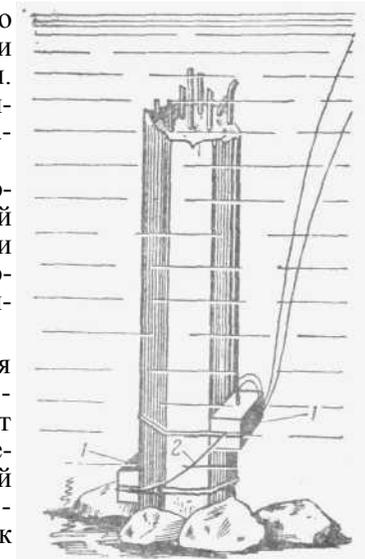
Перебивание железобетонной сваи: 1 — полузаряды ВВ; 2 — ДШ
